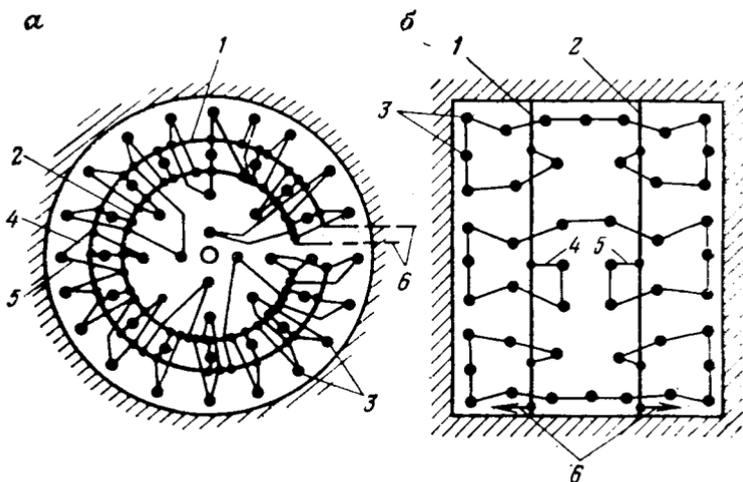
Схема соединения ЭД с антенной в круглых (а) и прямоугольных (б) стволах
